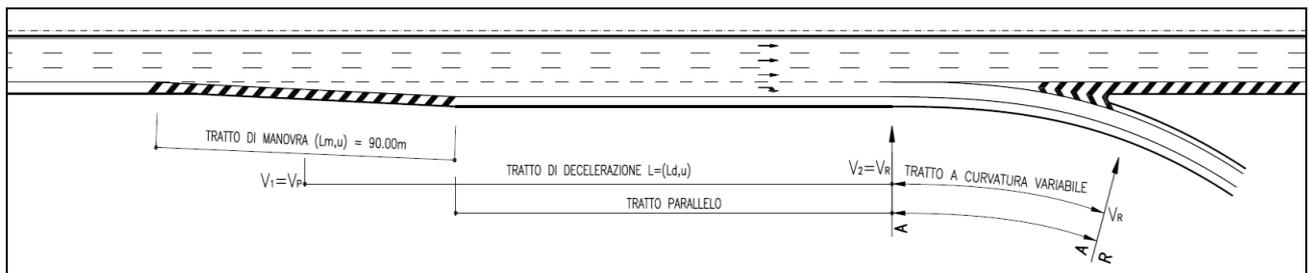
SCHEMA PLANIMETRICO DELLA CORSIA DI DIVERSIONE
